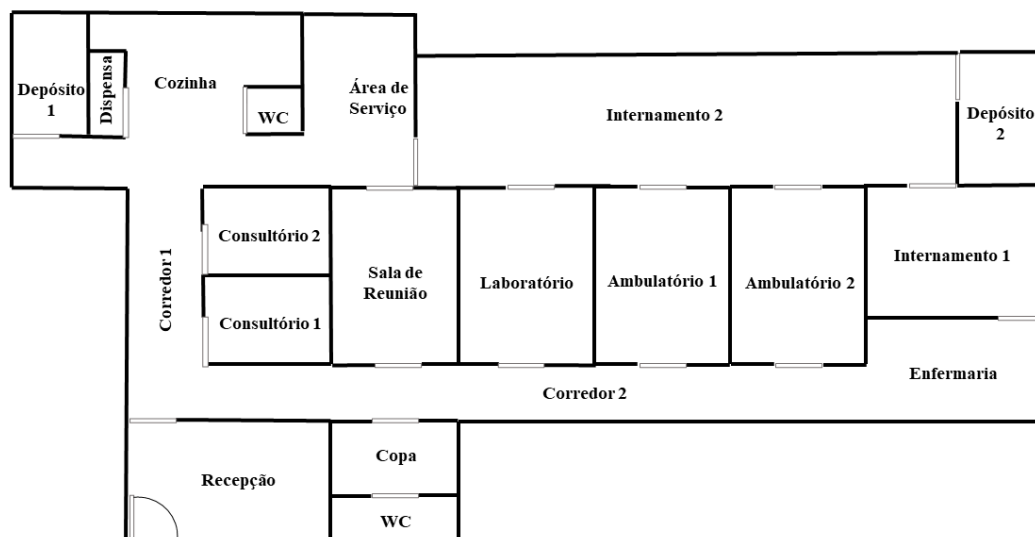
Planta baixa das instalações do SASE - UFBA. Fonte: Arquivo pessoal (2019).
